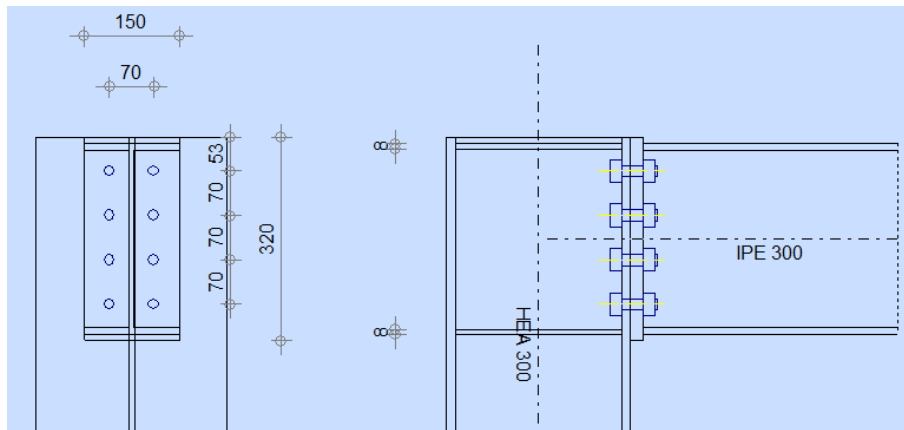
assemblage poutre- poteau (IPE 300- HEA300).
